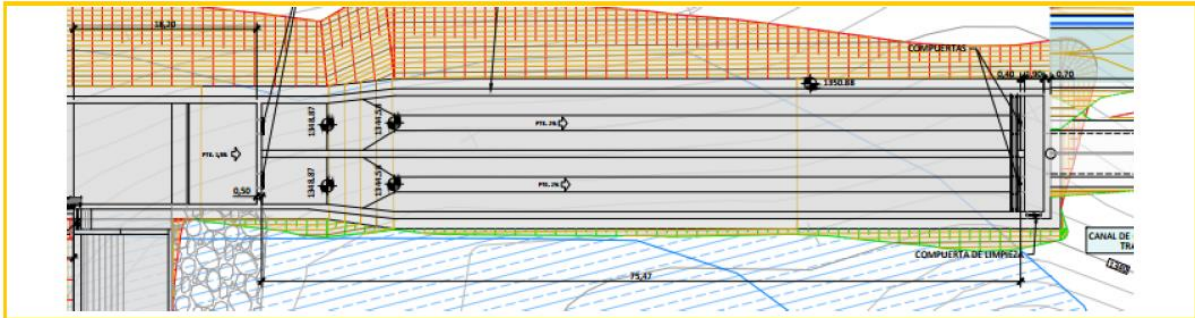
Esquema en Planta Desarenador de la Captación del Río Blanco
